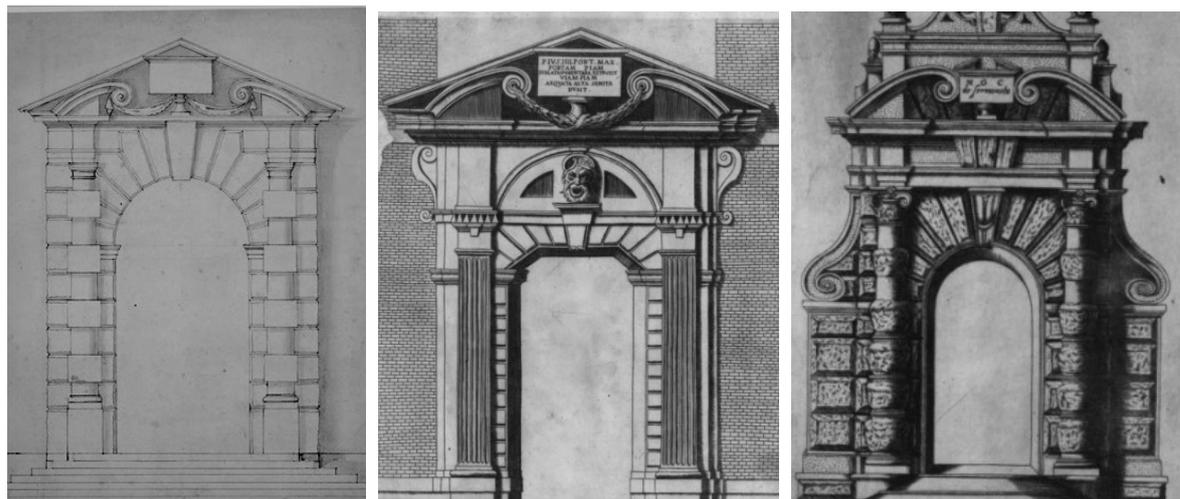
Inigo Jones, *Progetto per portale ad Arundel House, Londra, RIBA*;
